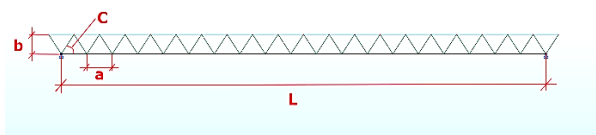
Модульный элемент. а – шаг узлов в ферме, b – высота фермы на опоре, с – угол наклона стержней в ферме и L – пролет фермы.
